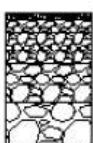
Perfil alternativa diseño de pavimento. Fuente: Propia.
